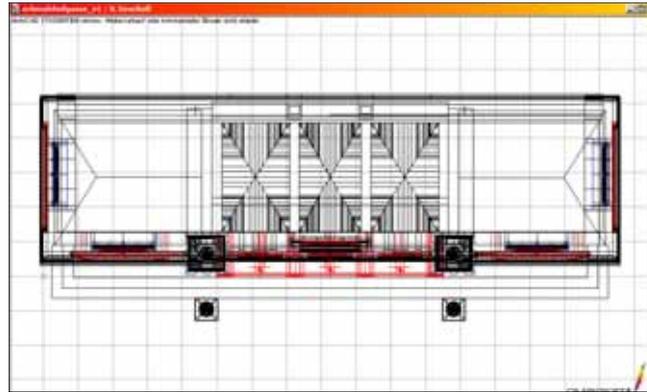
Grundriß der Ebene: "Objekt_11" (Hauptfassade)
